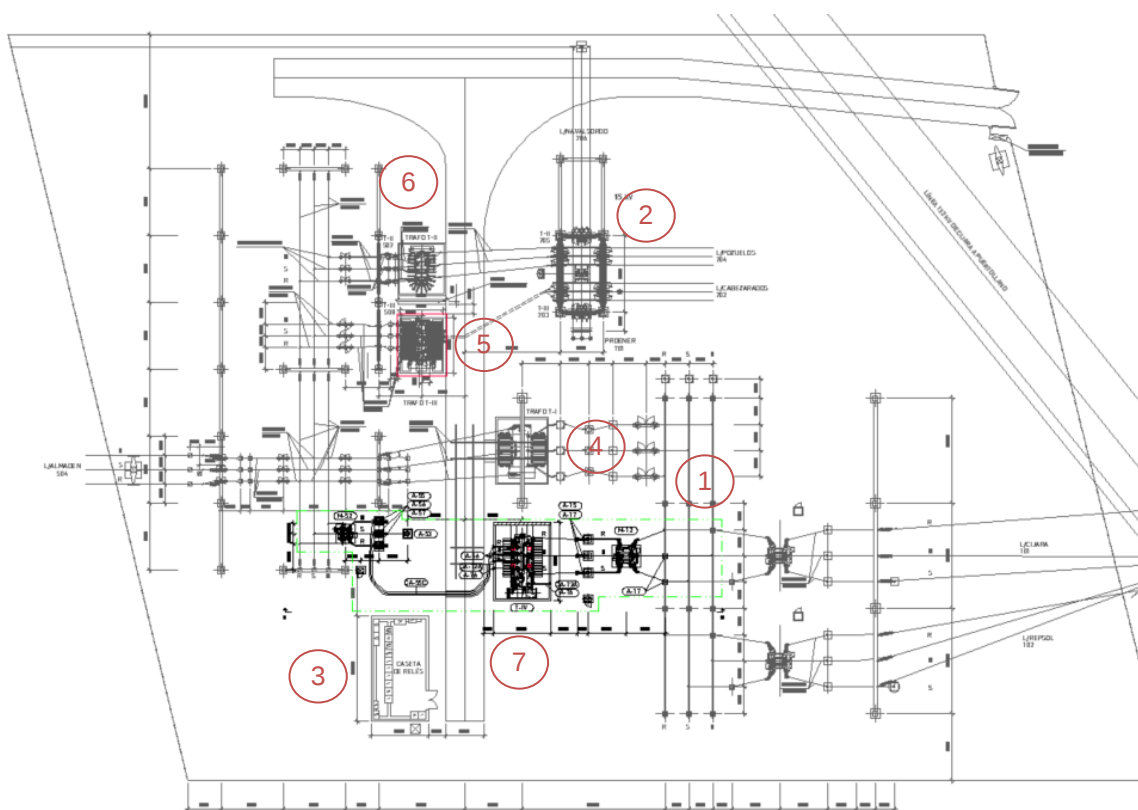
Planta general de la disposición de equipos de la subestación Abenójar
